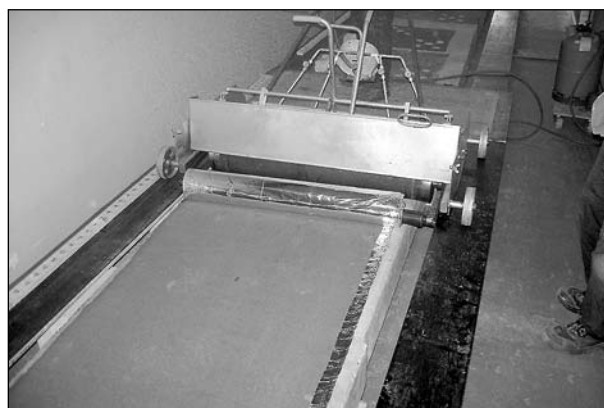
Aufschweiß-Verlegegerät mit abgewickelter Bitumenschweißbahn
